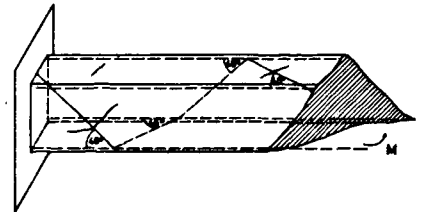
Armadura y grietas en un prisma sometido a torsión.
